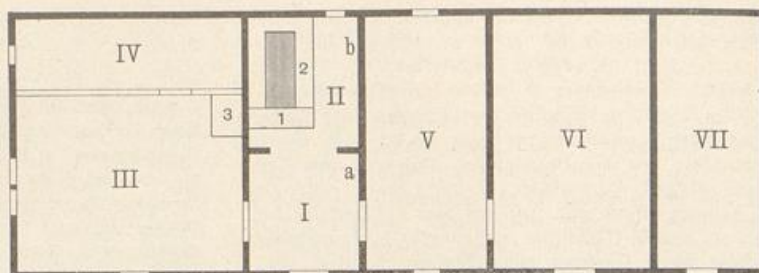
Josephinisches Haus in Unterbach (Gallizien): Grundriss.
